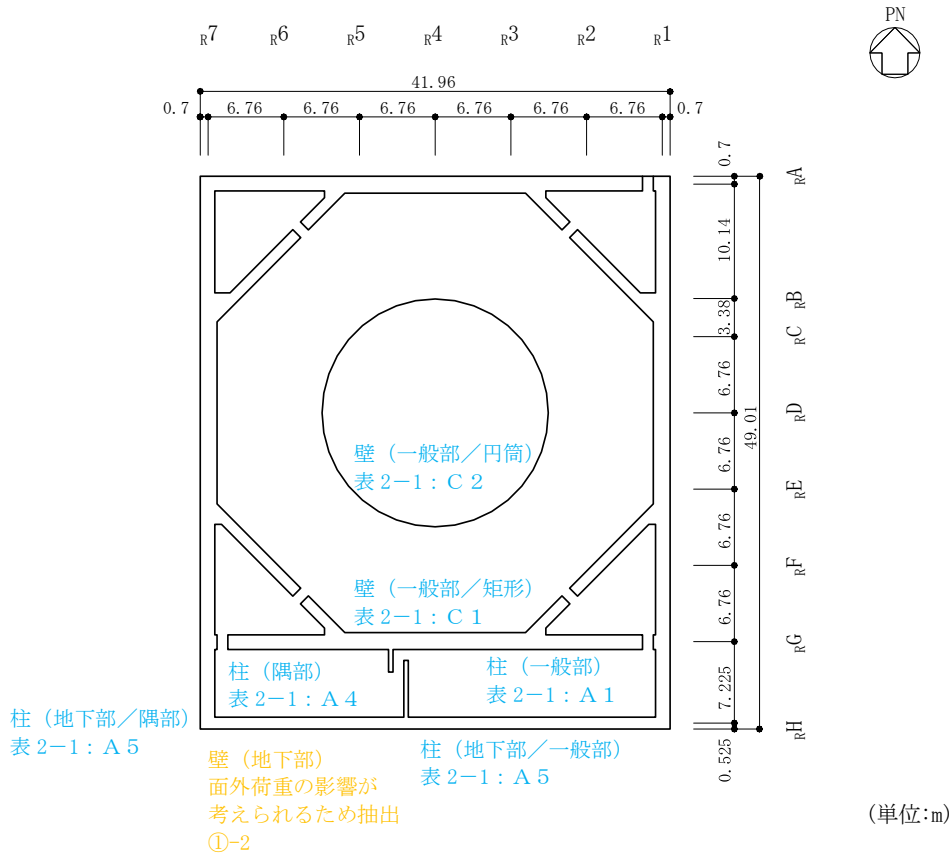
1号機原子炉建物の概略平面図 (EL 3.1m)
